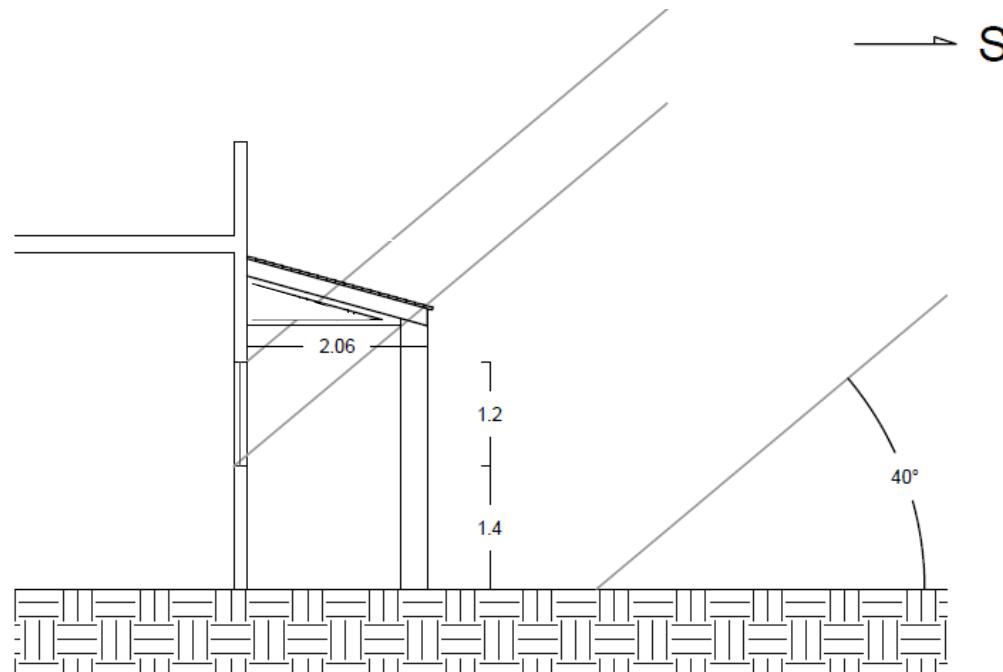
Propuesta de Dispositivos de Control Solar en Fachadas Sur
